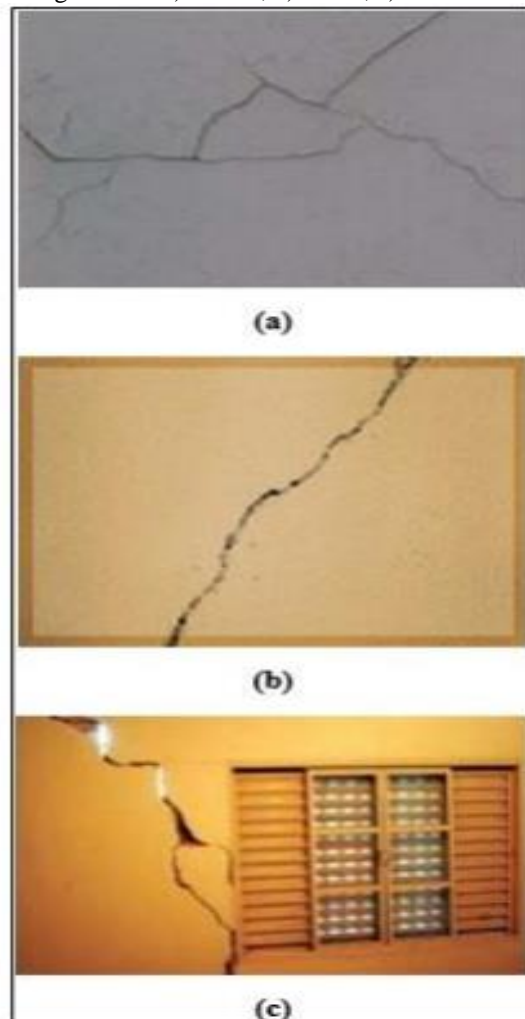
Tipos e incidência de fissuras em concreto armado.
